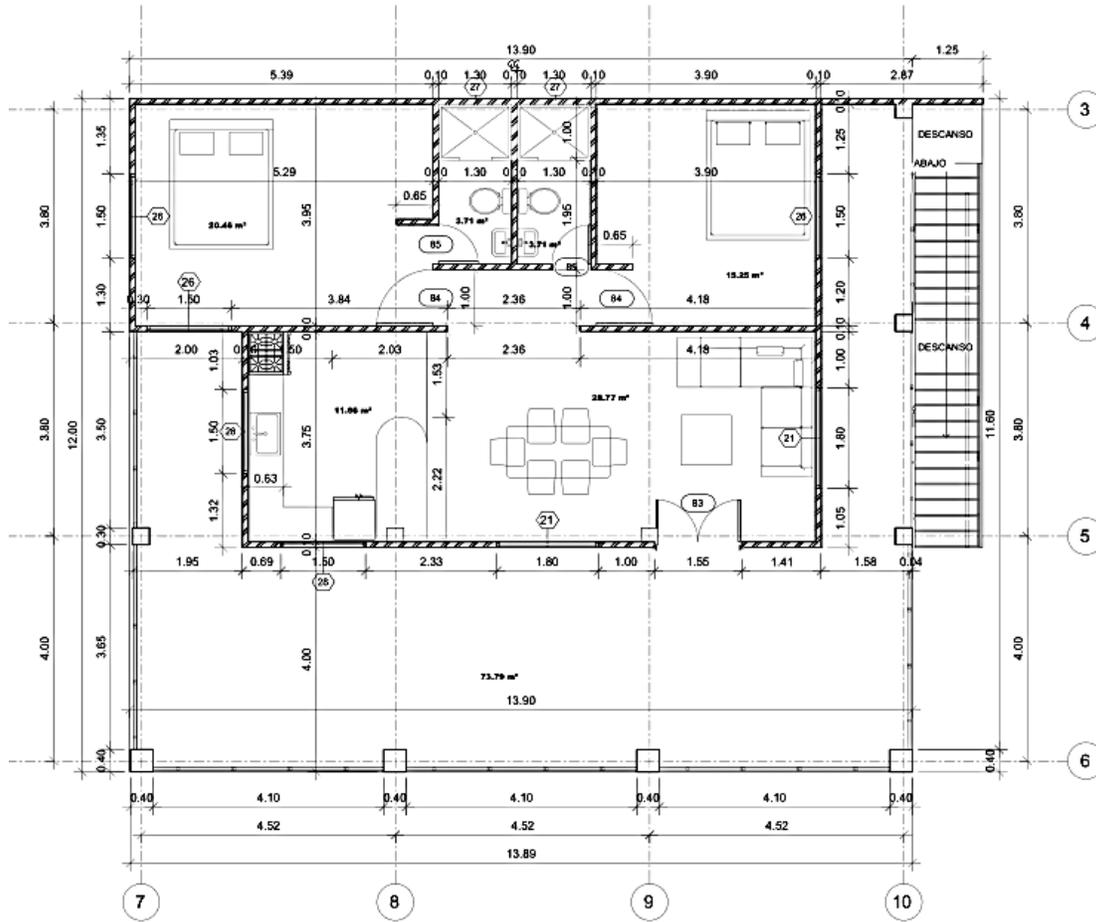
PLANTA BAJA ARQUITECTÓNICA
